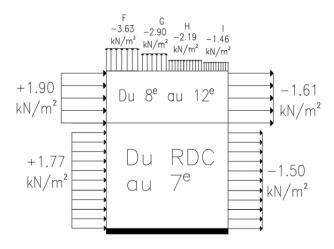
Valeurs des pressions W(zj) sur la construction en direction (V2)
